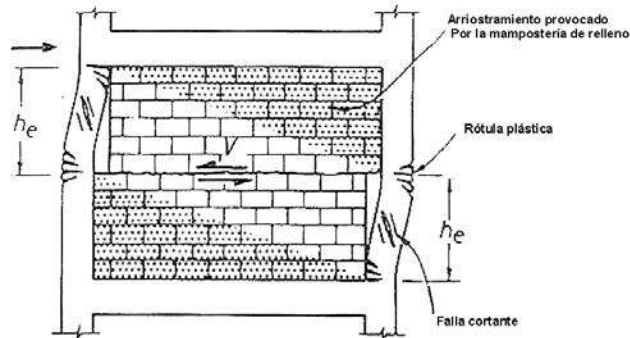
Posibles fallas de muro de marco relleno de mampostería. (Paulay, T., y Priestley, N. 1992).
